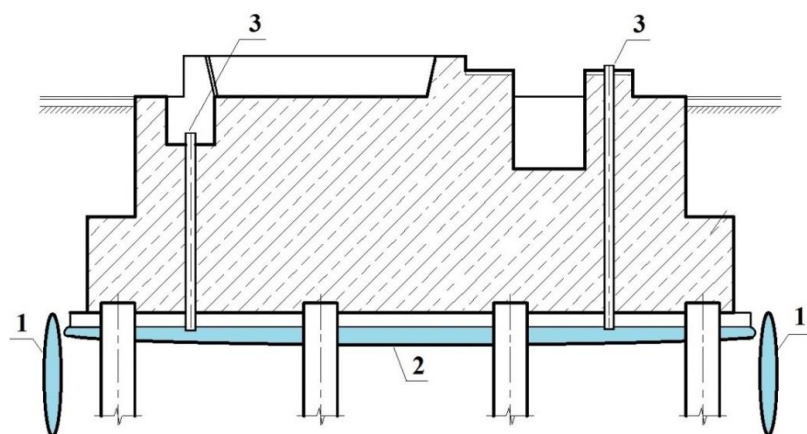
Усиление свайного фундамента под машину с динамическими нагрузками. 1 – сплошное контурное армирование, 2 – инъекционное тело под подошвой ростверка, 3 – отверстия в теле ростверка (патенты 2728077, 2729818 РФ).
